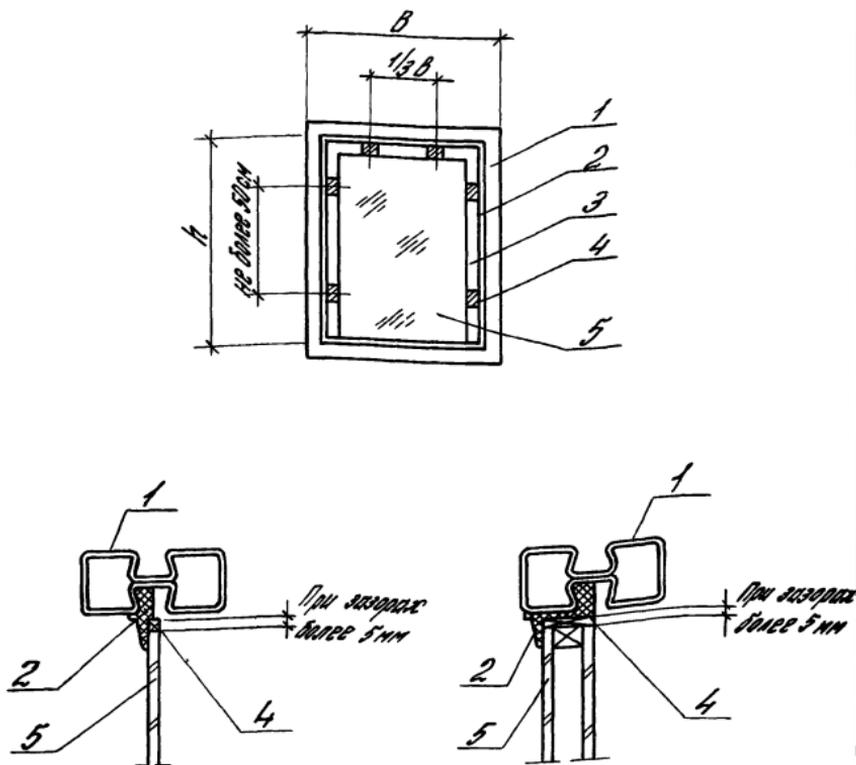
Рекомендуемая схема установки в зазоры резиновых клиньев
